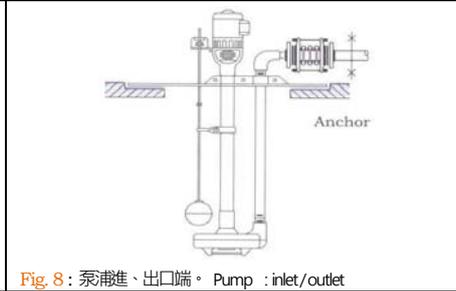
泵浦進、出口端。 Pump : inlet/outlet
